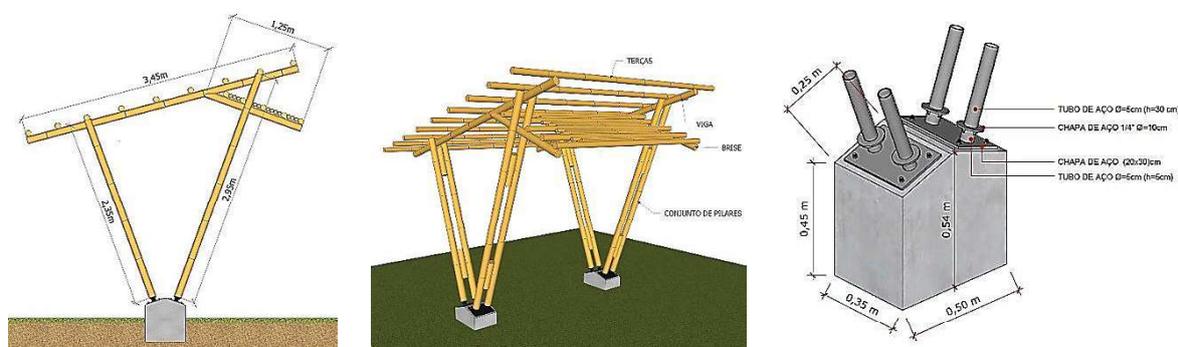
Proposta da estrutura do gazebo e detalhe da fundação
